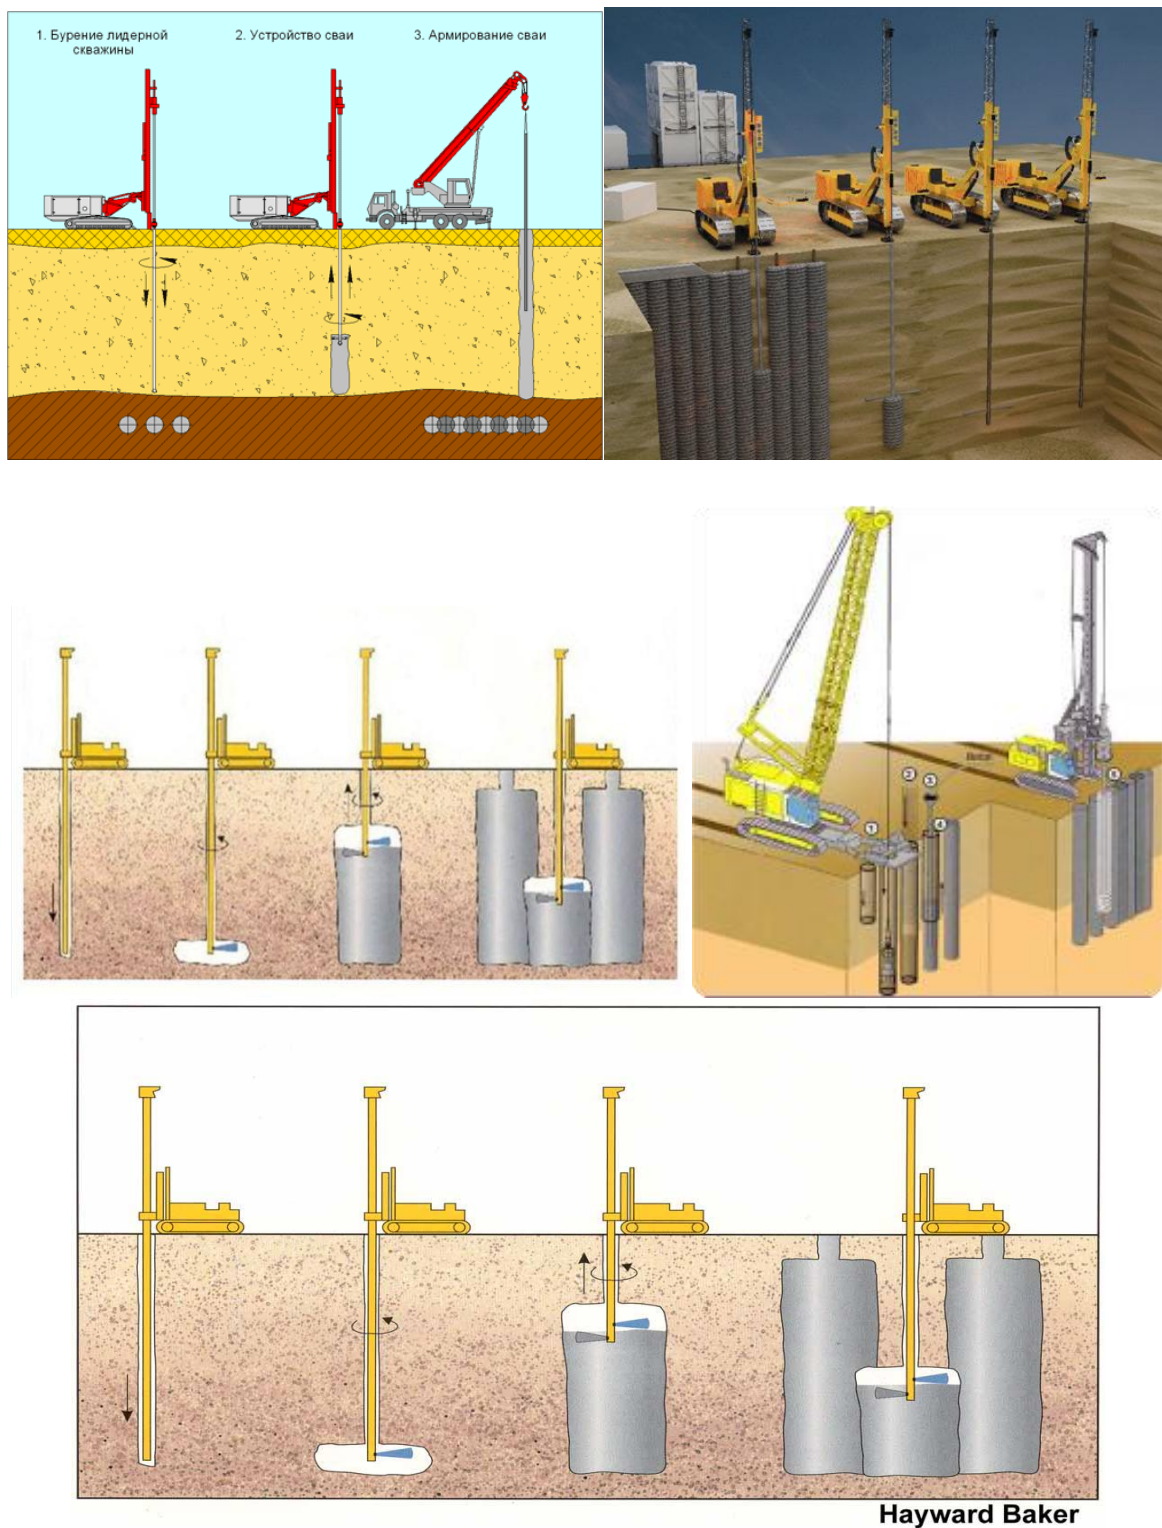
Послідовність улаштування огорожуючи стін котлованів за технологією «jet-grouting»
